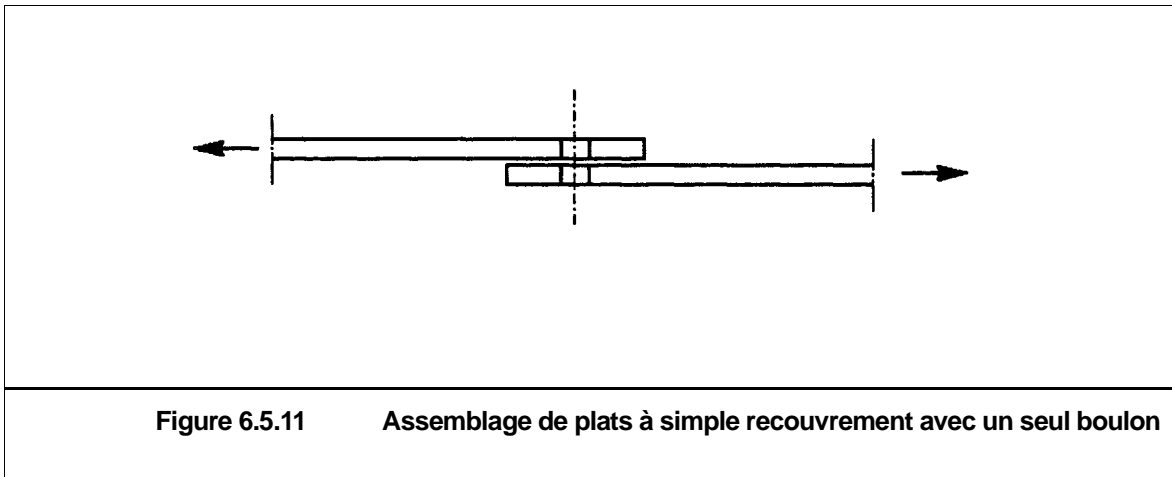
Assemblage de plats à simple recouvrement avec un seul boulon
